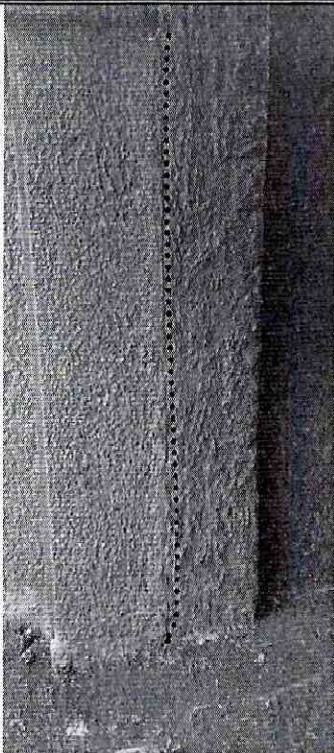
Vista del muro de cerramiento, costado sur occidental del Conjunto Residencial Conjunto La Floresta
